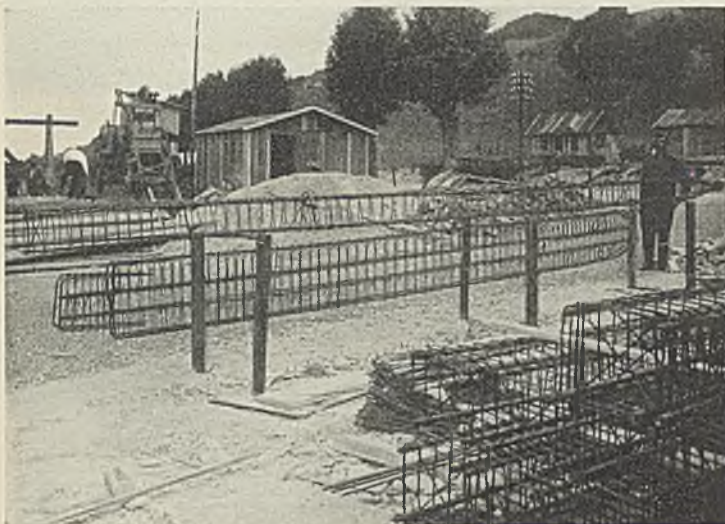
Eisengerippe der Pfahl- und Spundbohlenbewehrung.
